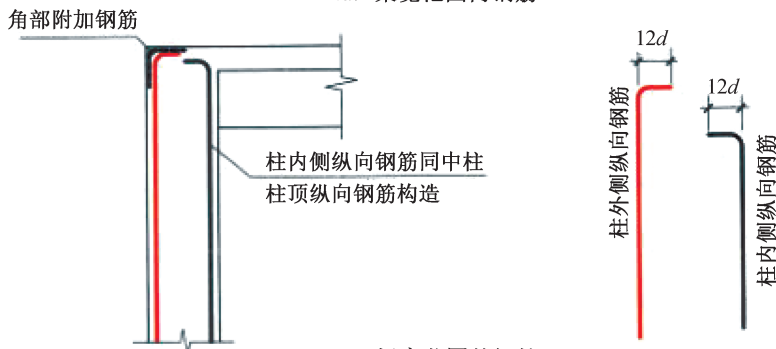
柱外侧纵向钢筋和梁上部纵向钢筋在节点外侧弯折搭接构造(续)
